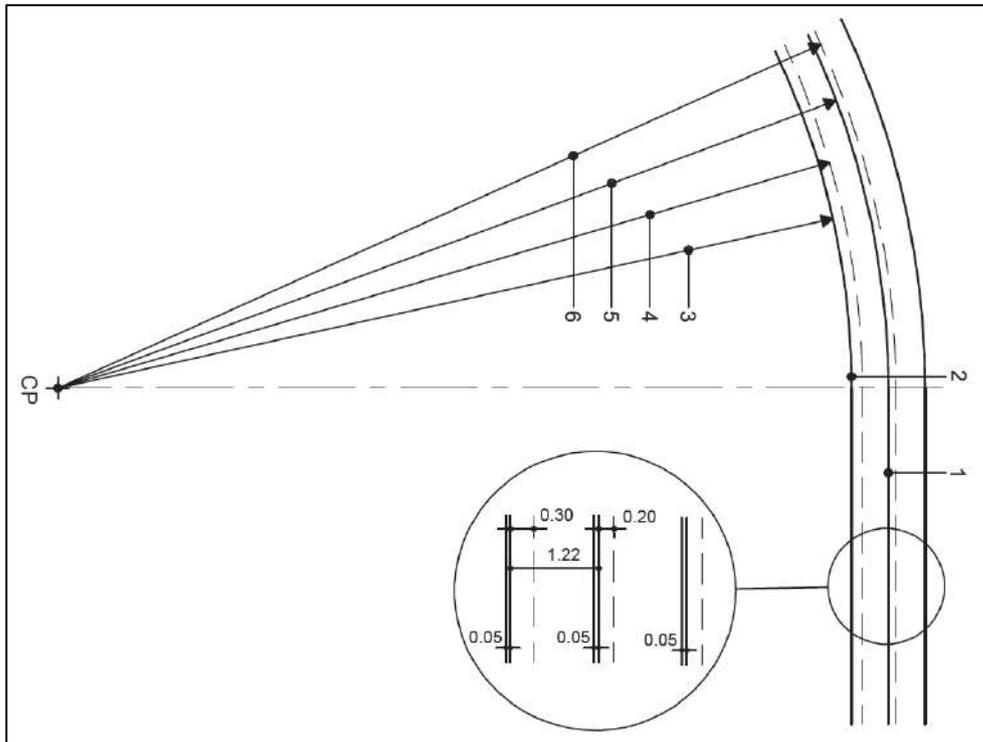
Cálculo de la longitud de vía de la vía estándar de 400 m (Dimensiones en m)
